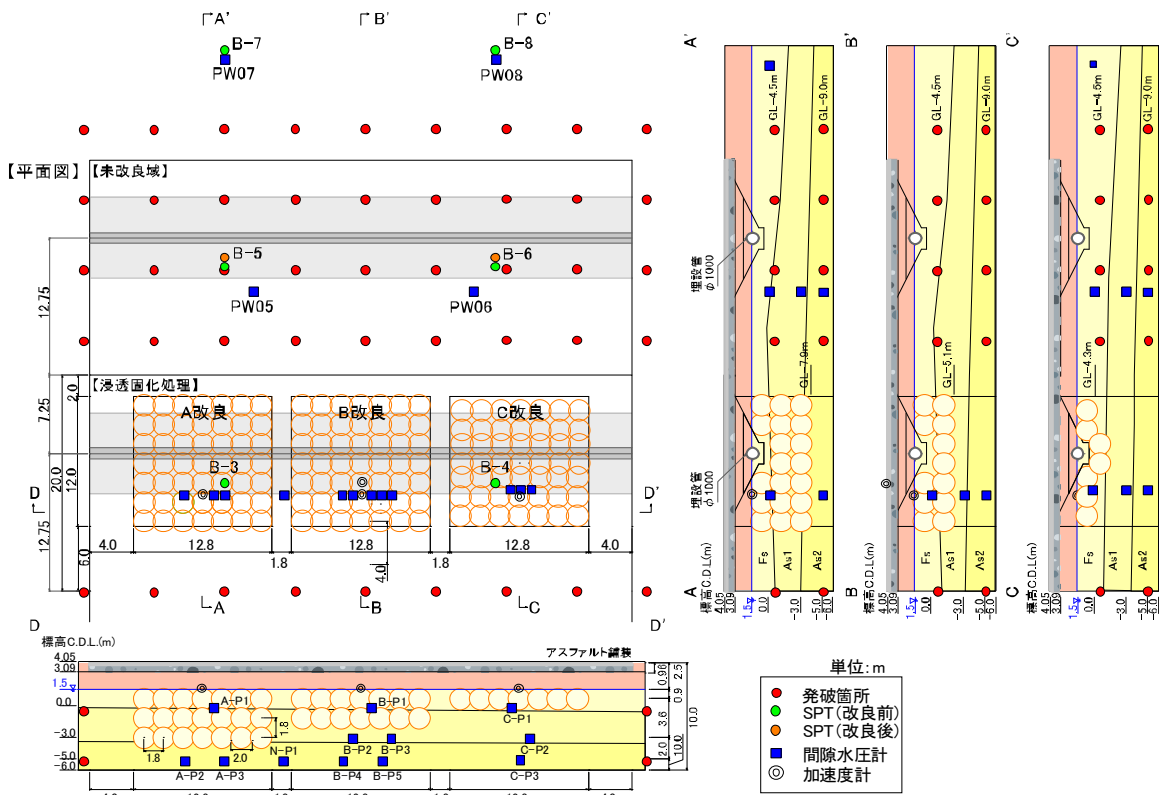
溶液型薬液注入工法（A～C）の施工断面・平面図（単位：mm）
